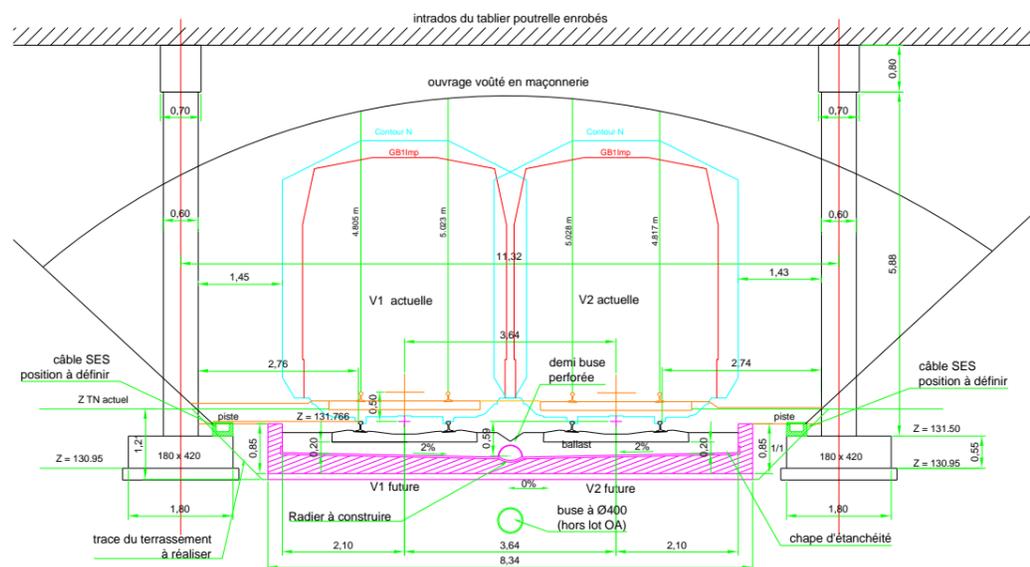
Coupe du Pont Route du chemin des Princes (Source : AVP- juillet 2015)
